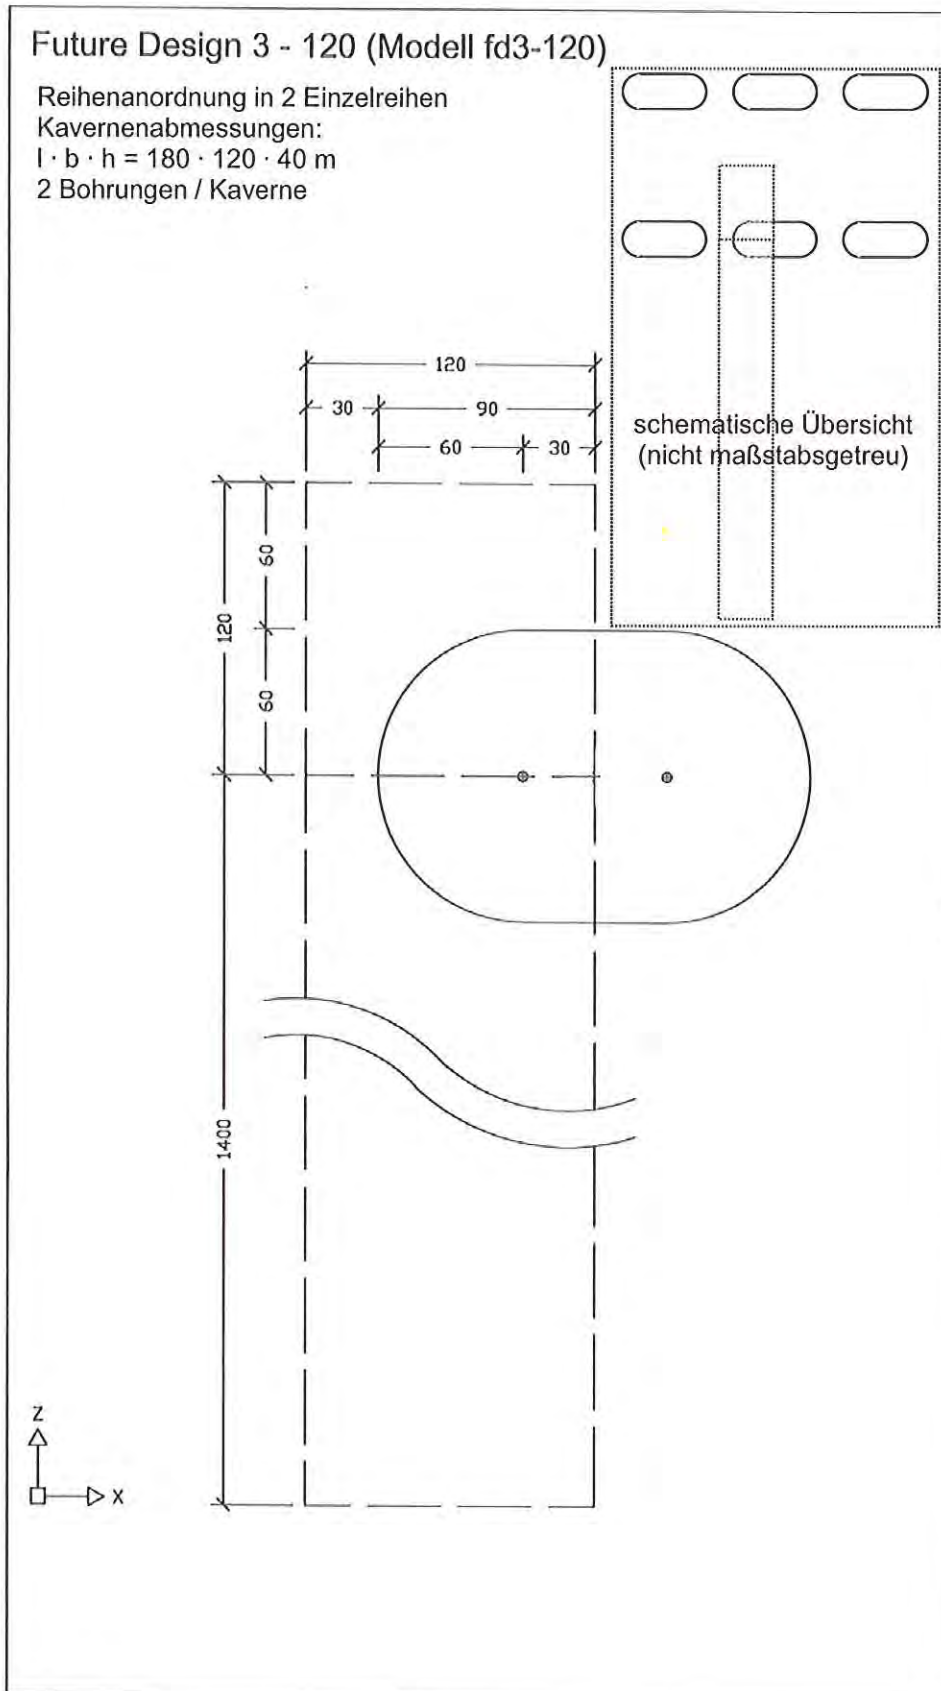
Future Design 3-120 – Grundriss
